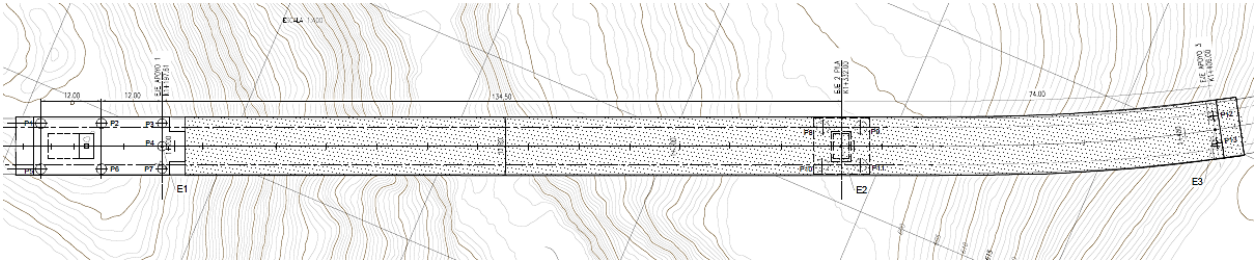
Planta puente caso de estudio 1. Tomado de plano planta perfil del puente.
